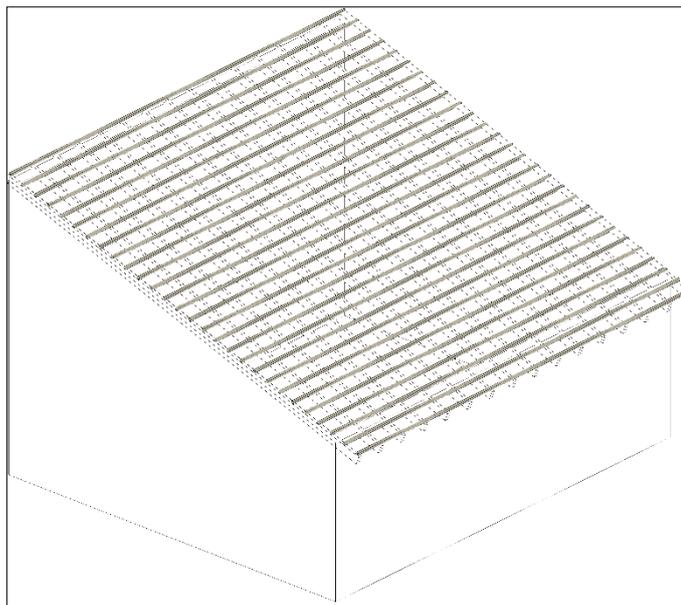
Planta demonstrando os elementos estruturais e seus vãos.
